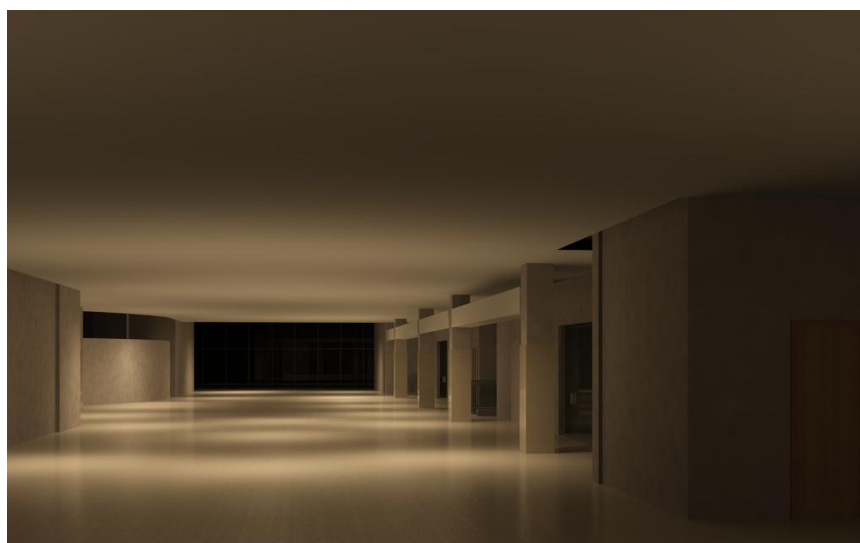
Imagem 3D sem infraestruturas à vista
